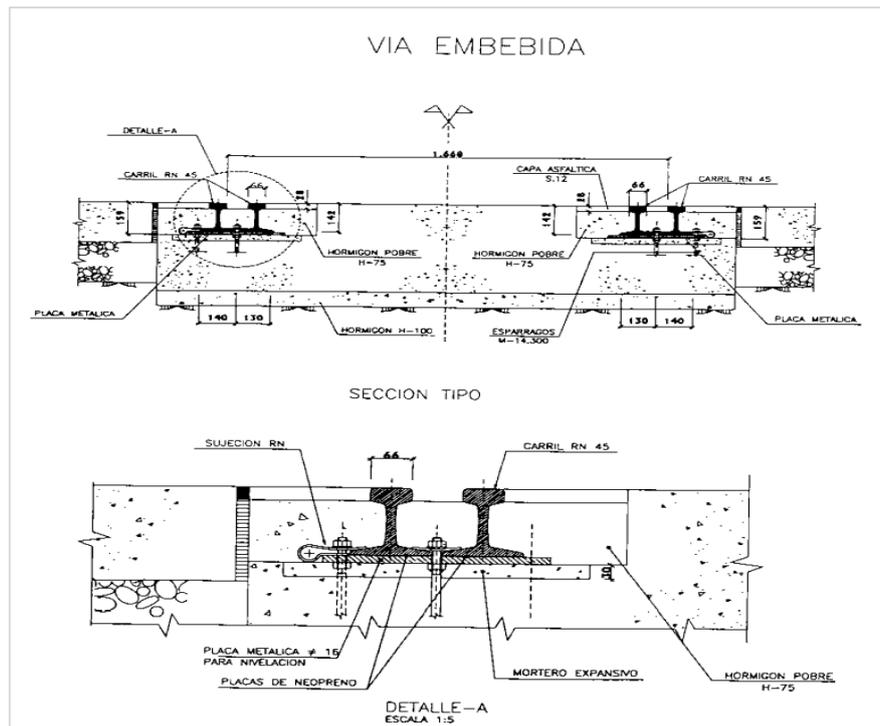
Sección Tipo de Vía en Placa Embebida. Fuente: Ferrocarril de Mercancías en el Ámbito Portuario
